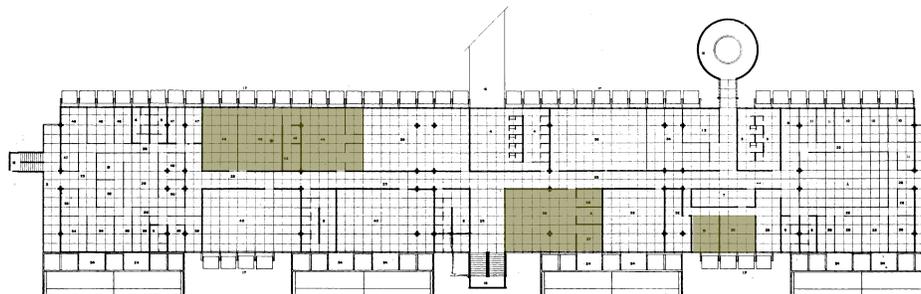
Planta de localização -laboratórios do 2º pavimento
